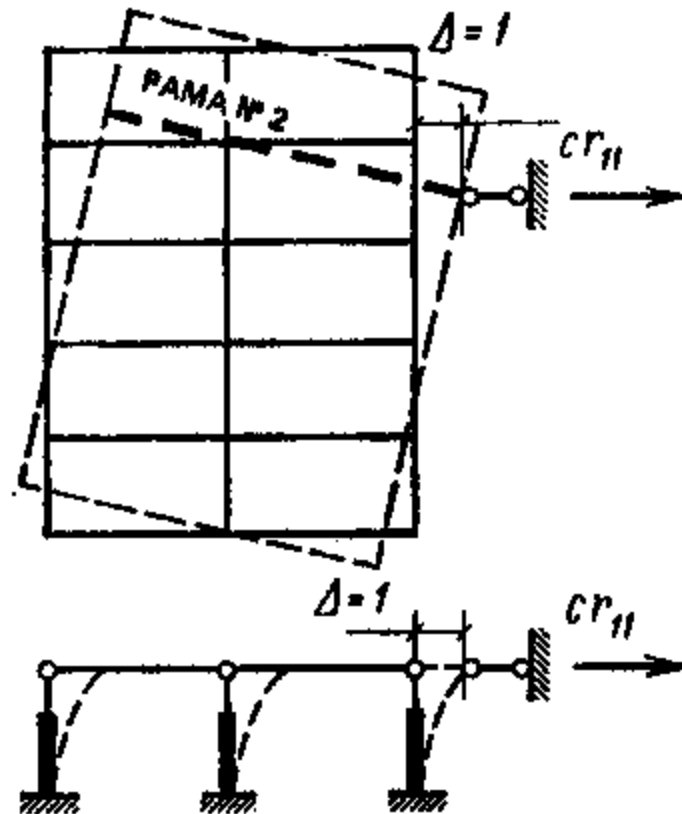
К пространственному расчету одноэтажного каркасного здания на крановые нагрузки
